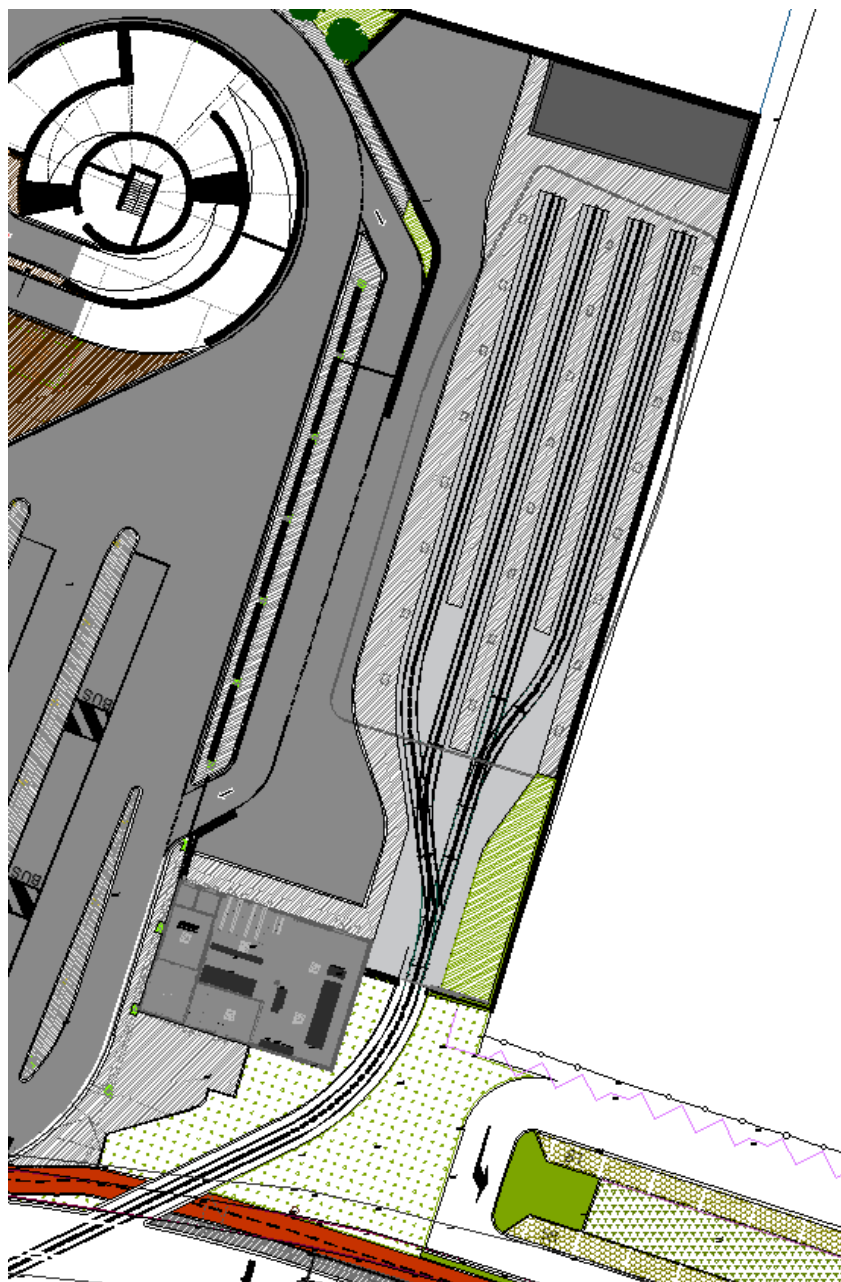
Planimetria di progetto Ricovero mezzi Castel Maggiore
